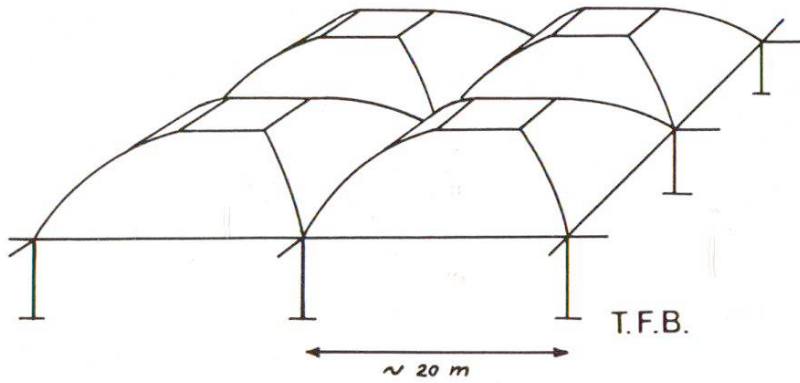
Toiture d'un entrepôt. (Concrete and Constructional Engineering, 47, 11, (1952)
